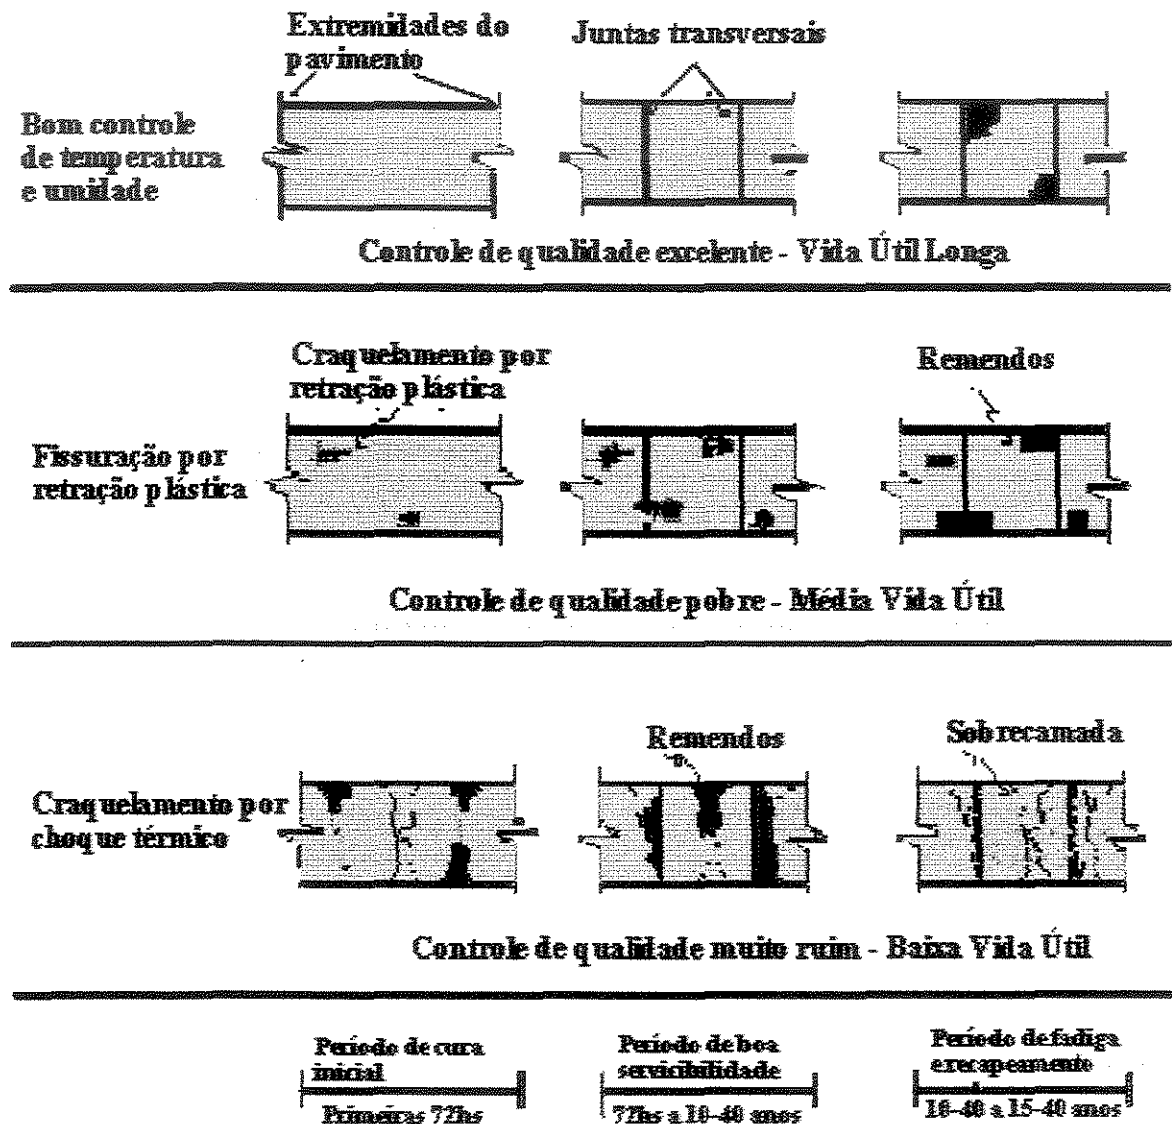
influência do controle de qualidade, adotado na construção, sobre a durabilidade do pavimento de concreto. FHWA (10)
